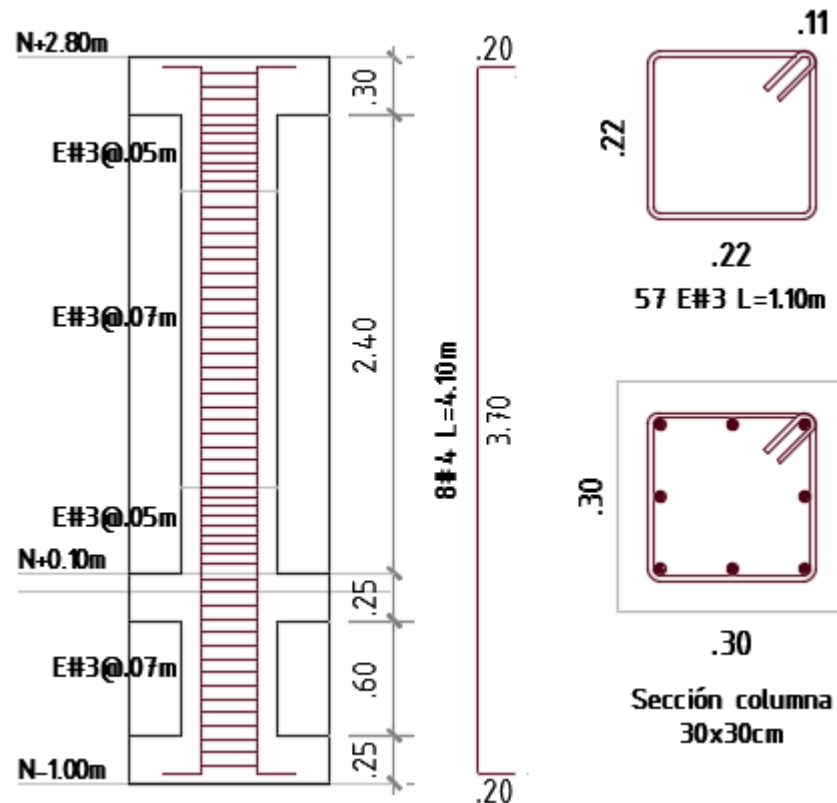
Detalle de columna típica en sistema tipo pórtico de dos pisos
